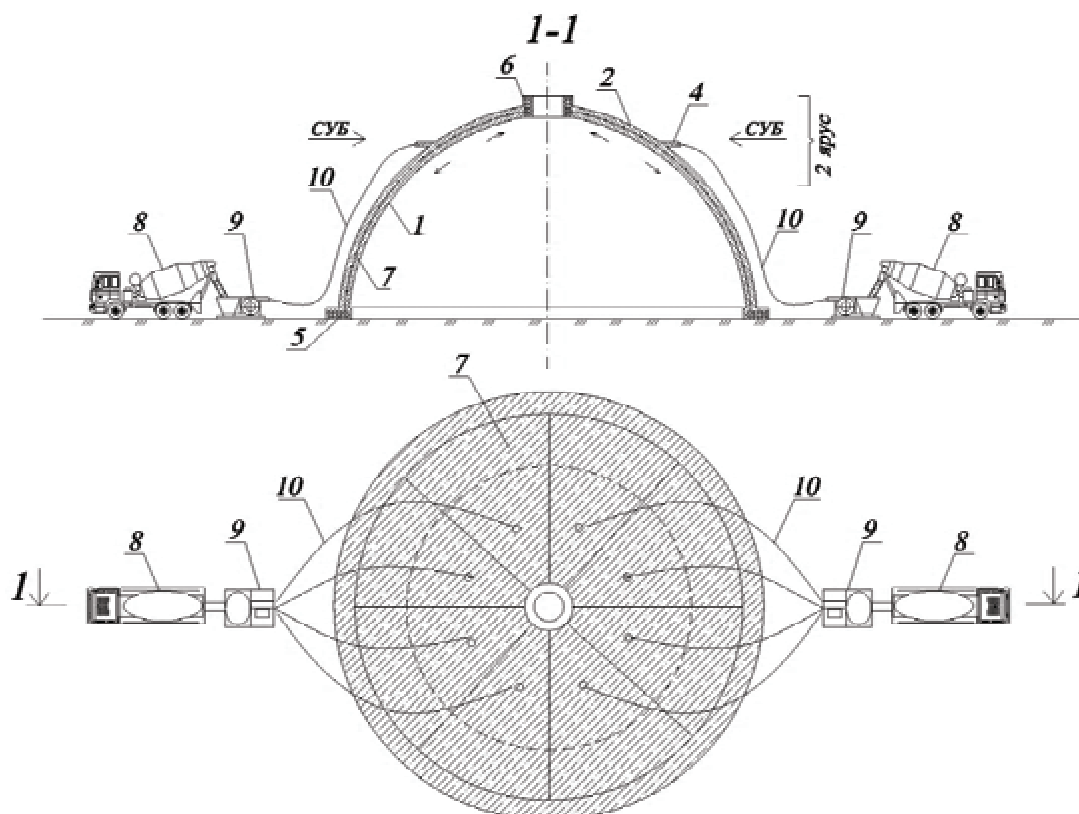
Бетонирование второго яруса купола: 1 – внутренняя опалубка; 2 – наружная опалубка; 3 – арматура купола; 4 – штуцеры для подачи бетона; 5 – нижнее опорное кольцо; 6 – верхнее опорное кольцо; 7 – самоуплотняющийся бетон; 8 – автобетоносмеситель; 9 – роторный насос; 10 – шланг.
